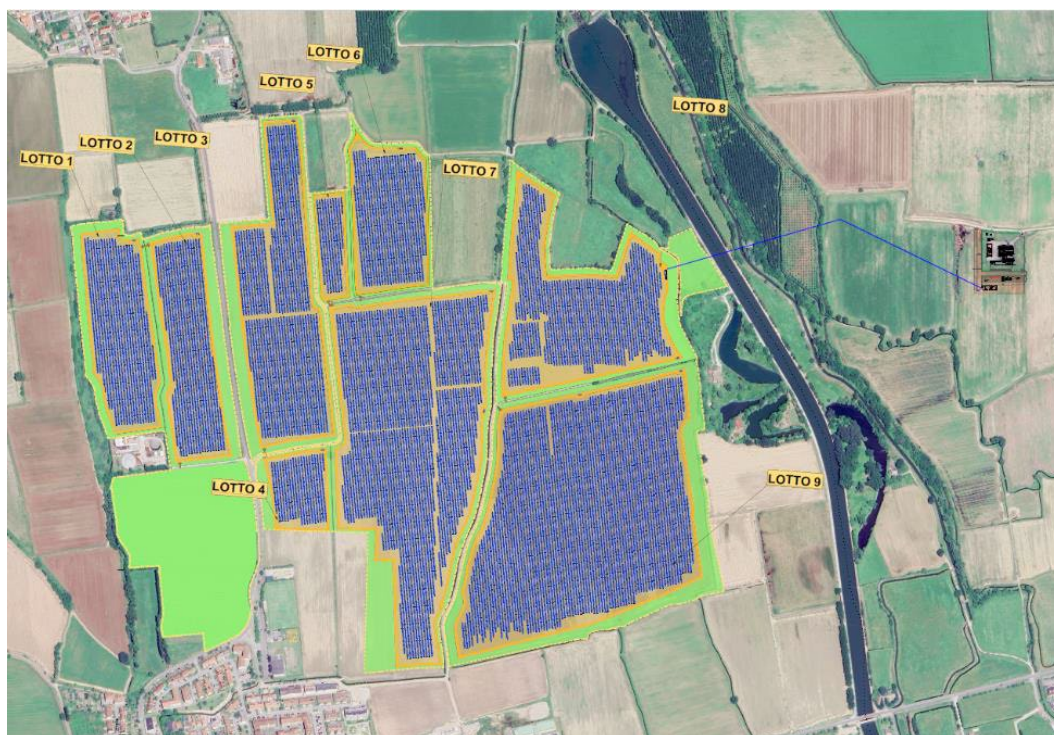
Planimetria generale del progetto (lotti e stringhe)
